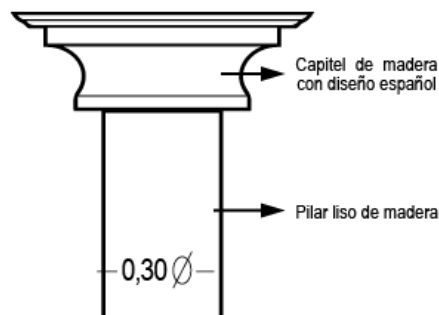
En la ilustración se observa el detalle del capitel que corona el pilar estructural de la galería o pasillo de la vivienda. Este diseño se repite en cada uno de los pilares estructurales de toda la galería posterior de la vivienda.
